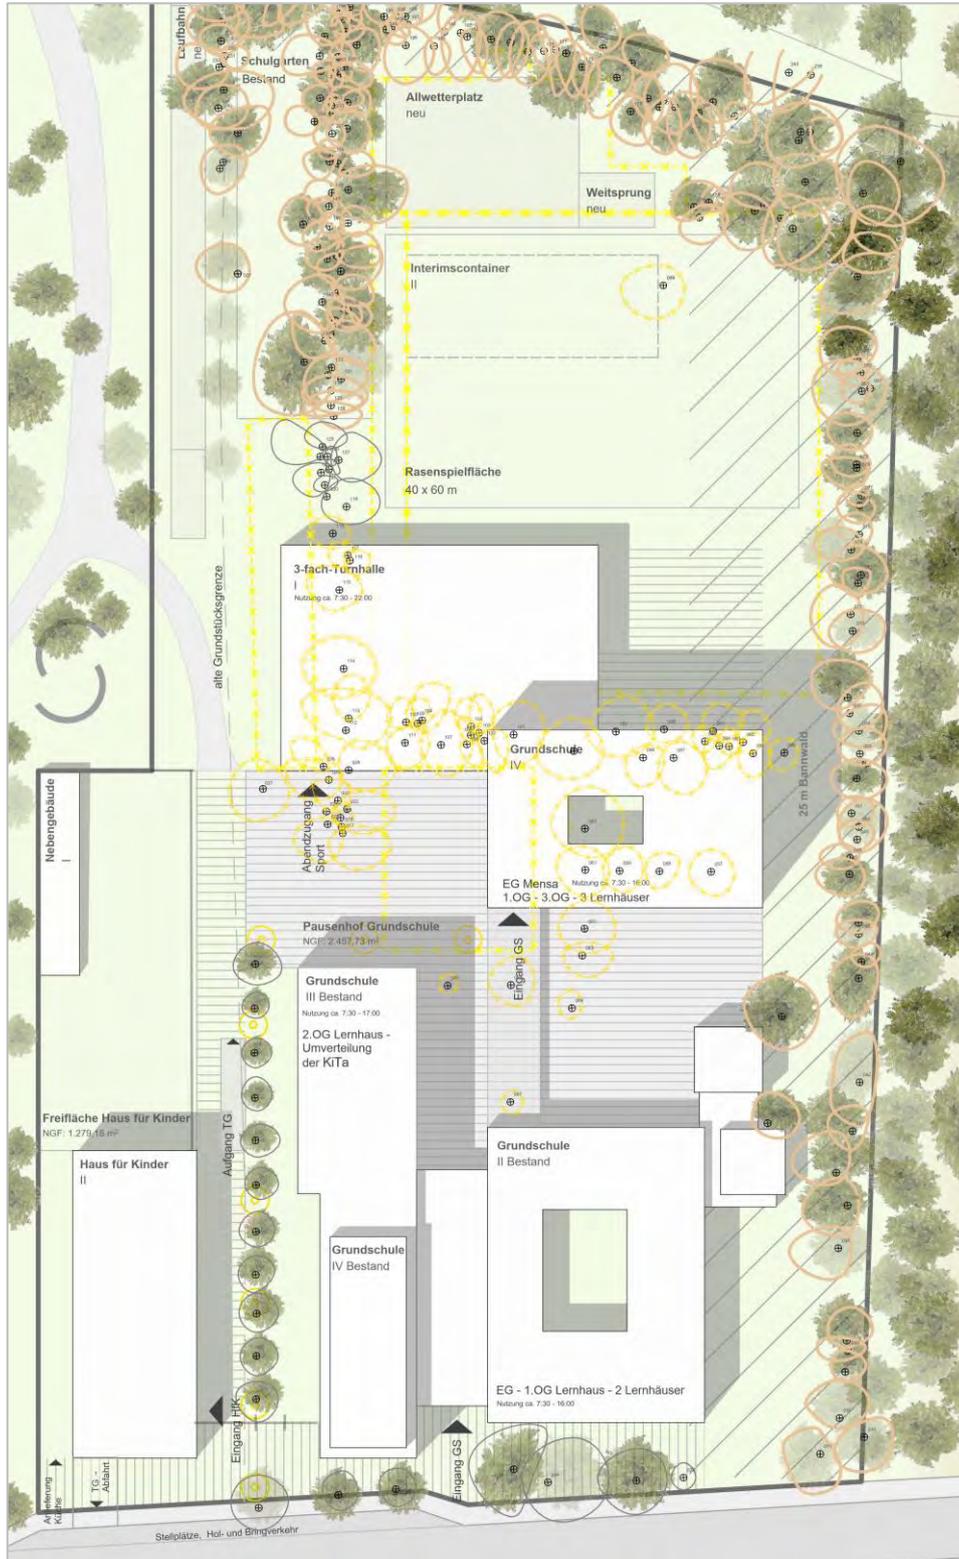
Lageplan Variante 1 [Quelle: LHM; Stand 09.10.2019]
